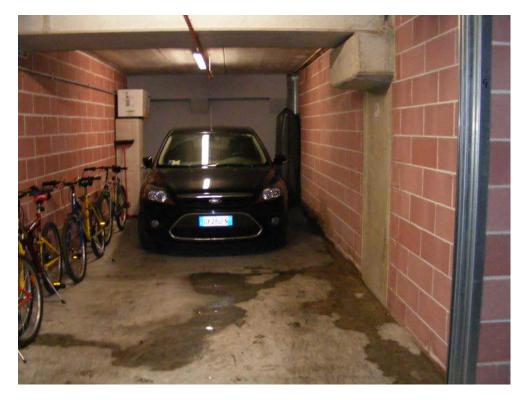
Autorimessa 4 Box 09. Infiltrazione lungo il pilastro.
